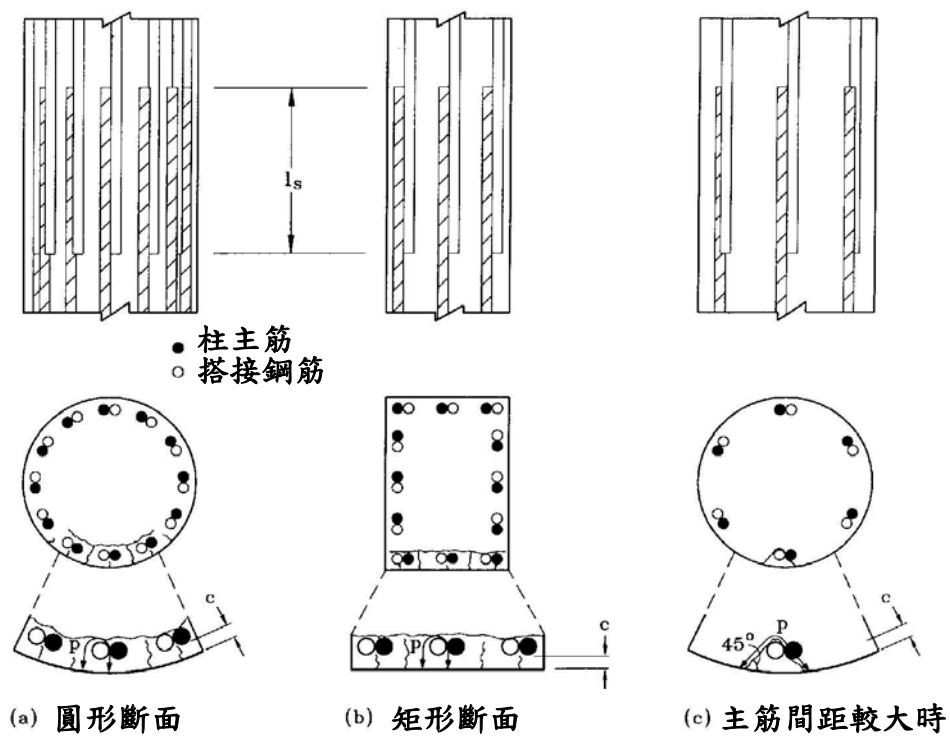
柱搭接鋼筋混凝土之劈裂
